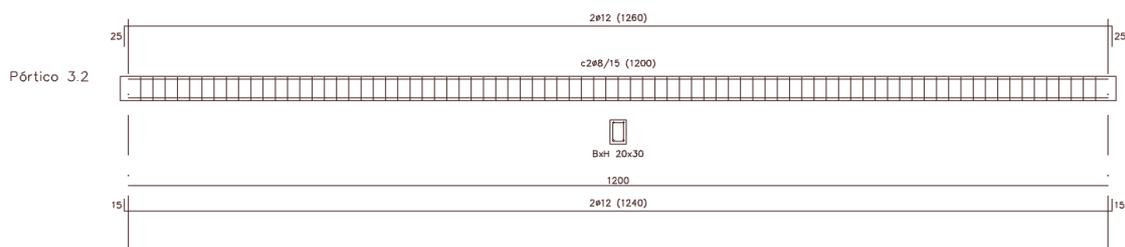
Propuesta de armado para una viga de 12m de longitud.
